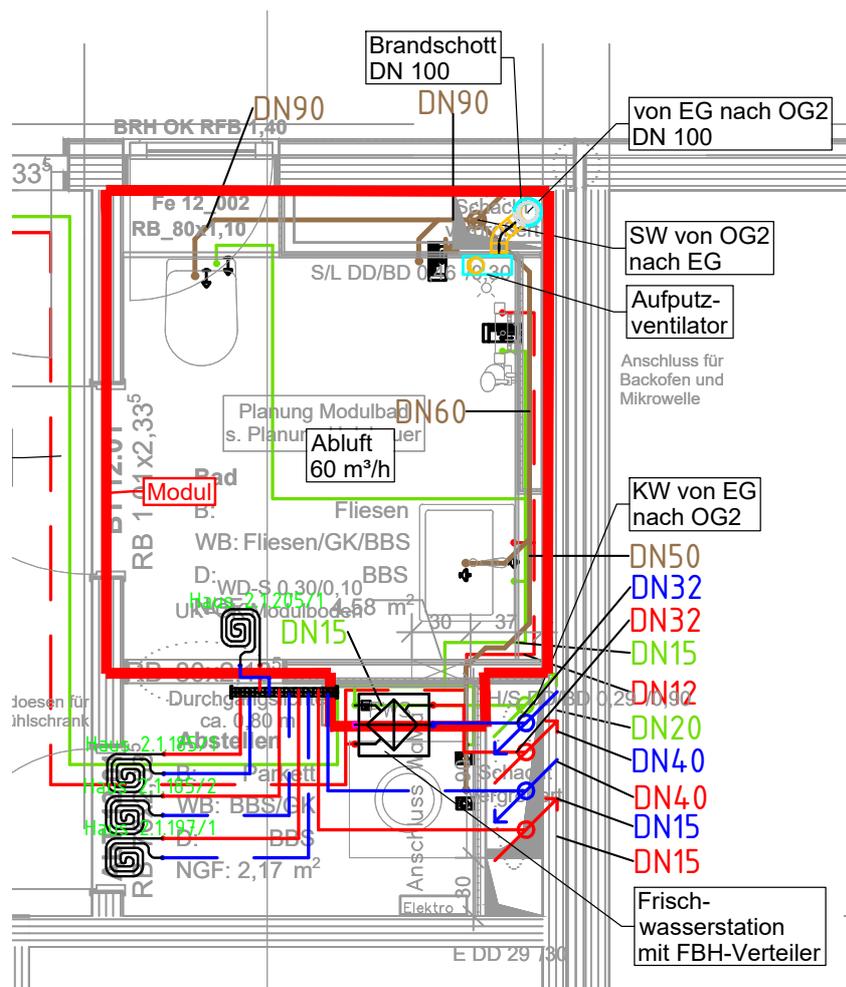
Grundriss Badmodul (technische Umsetzung)
